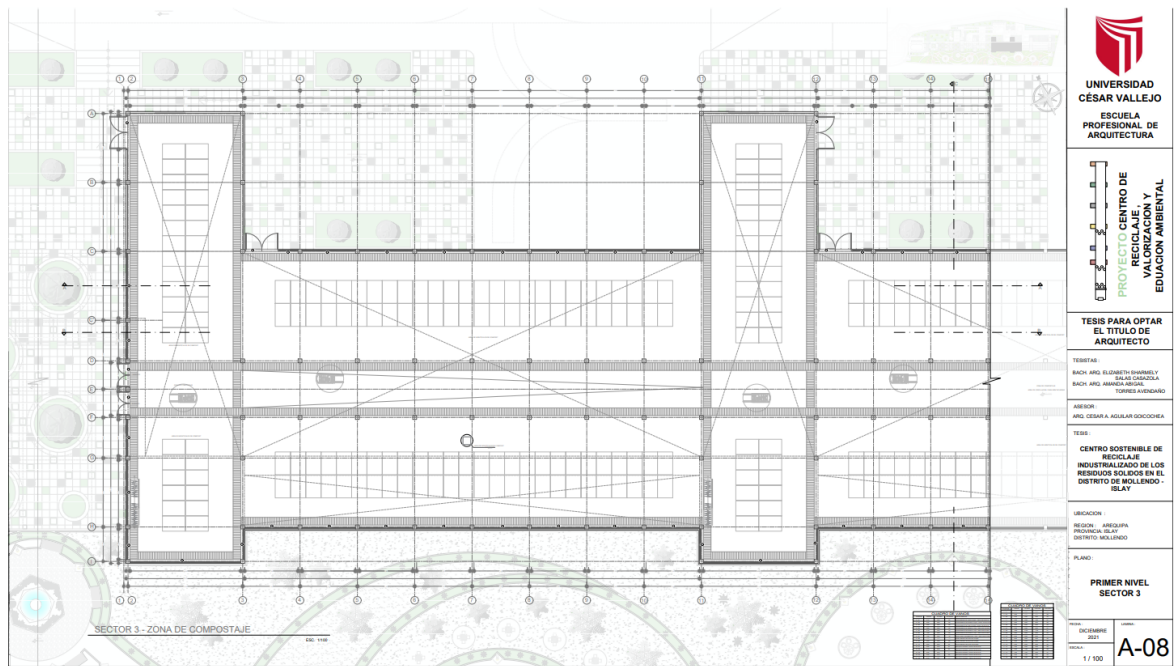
Planta de Distribución, Sector 3 – Primer Nivel
